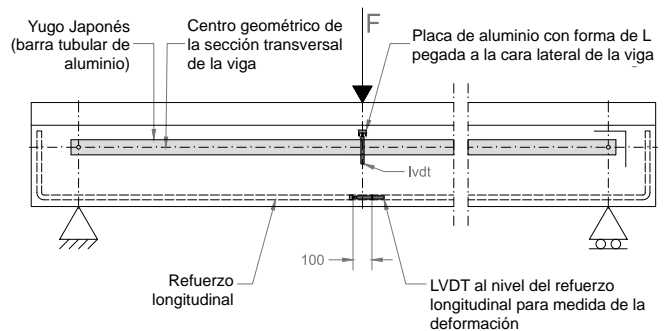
Croquis de las medidas de deflexión y deformación de la viga (dimensiones en mm).
